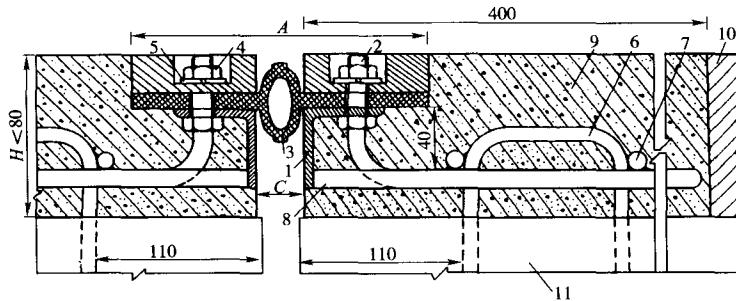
管形橡胶条型伸缩装置构造示意图(尺寸单位:mm)
